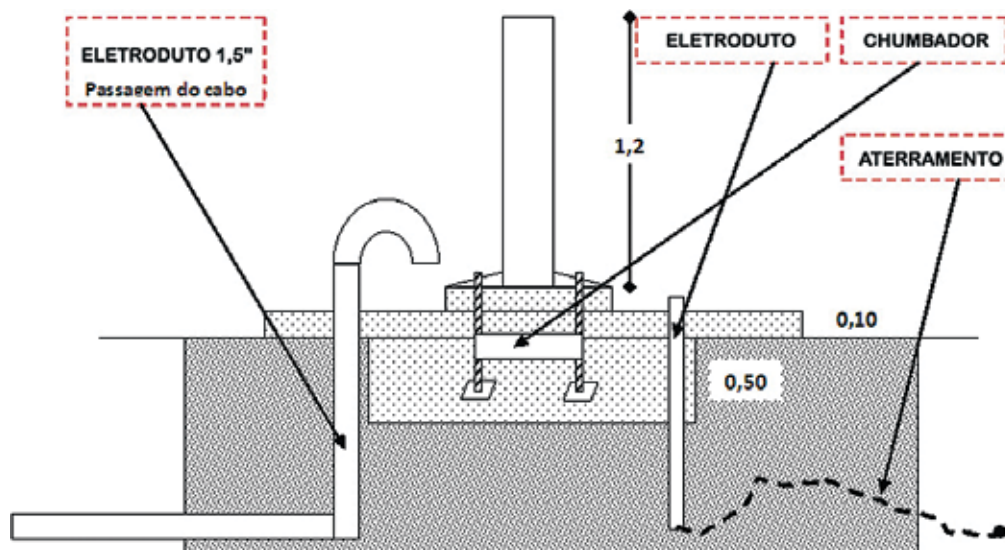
Desenho técnico – Eletrodutos e base de fixação completa
